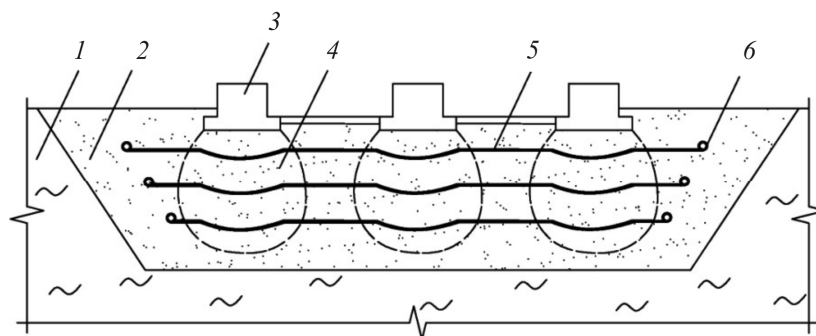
Фундаменты, опирающиеся на песчаную подушку с преднапряженным армированием: 1 – слабый грунт; 2 – песок; 3 – фундамент; 4 – область действия создаваемых фундаментом вертикальных сжимающих напряжений; 5 – армирующий материал; 6 – анкерующий элемент
